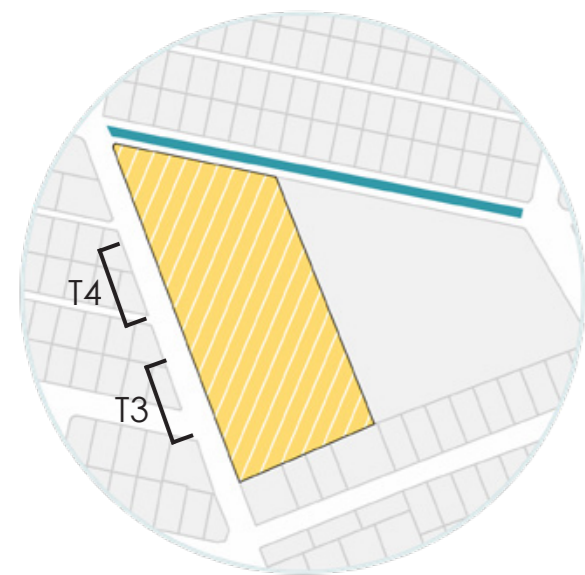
Planta ubicación calle E. Fuente: Elaboración propia.
